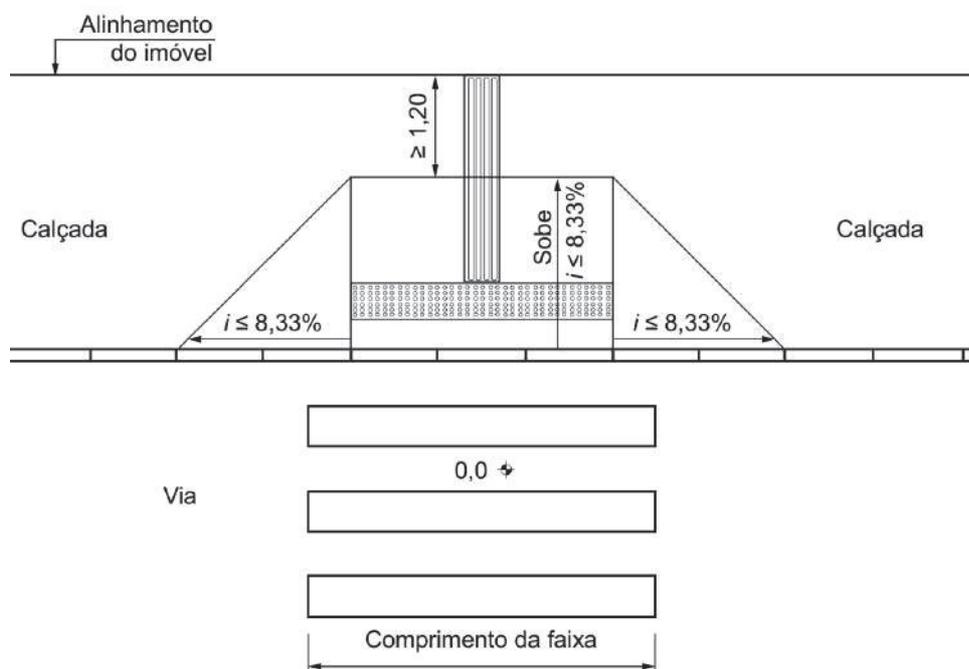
Rebaixamentos de calçada – Vista superior (dimensões em metros)
